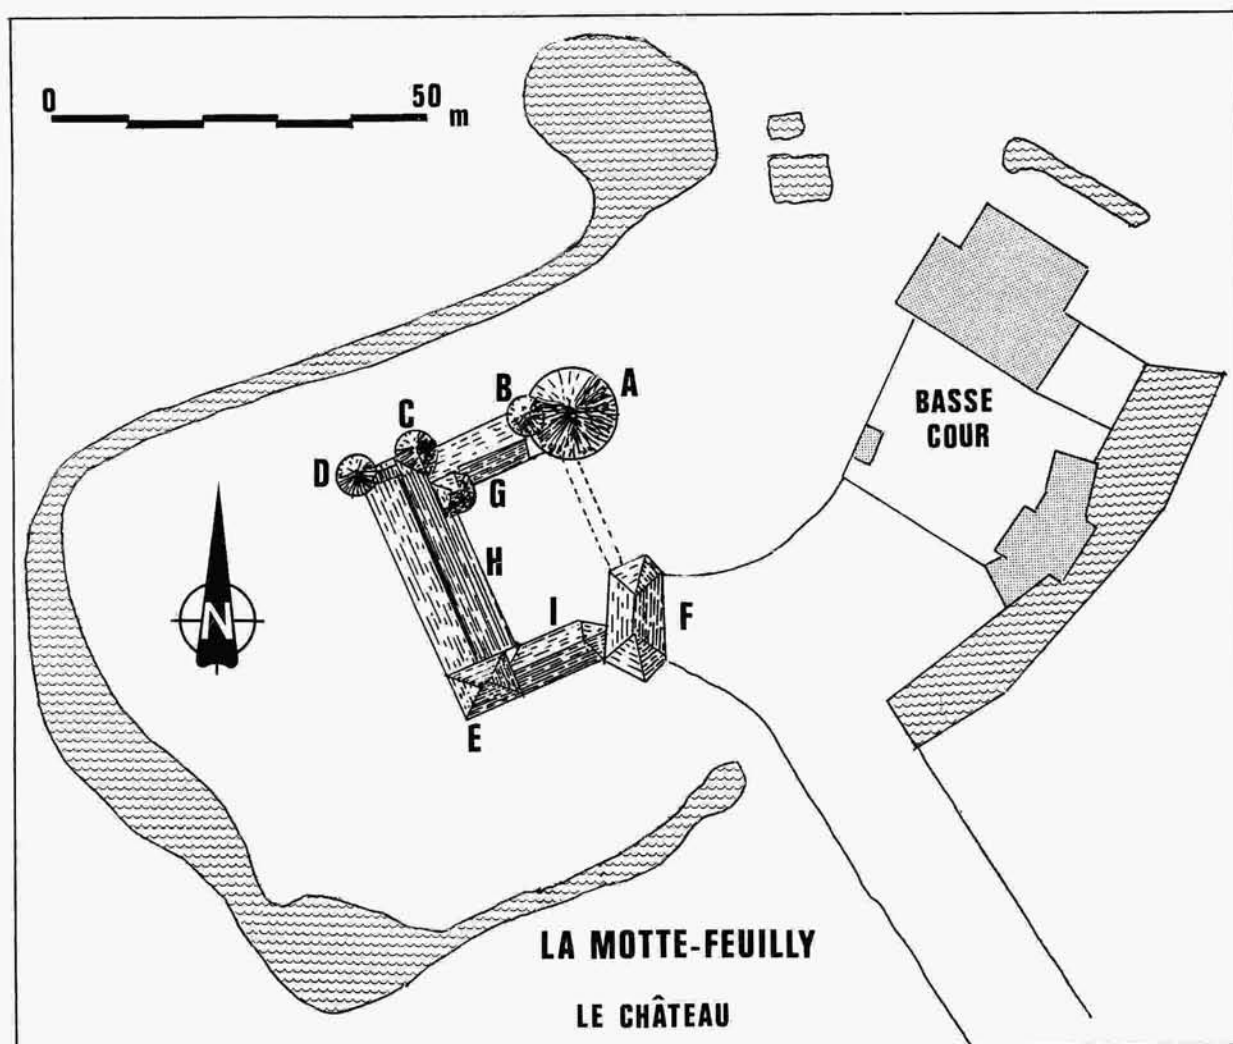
PLAN DE MASSES ACTUEL DU CHÂTEAU
